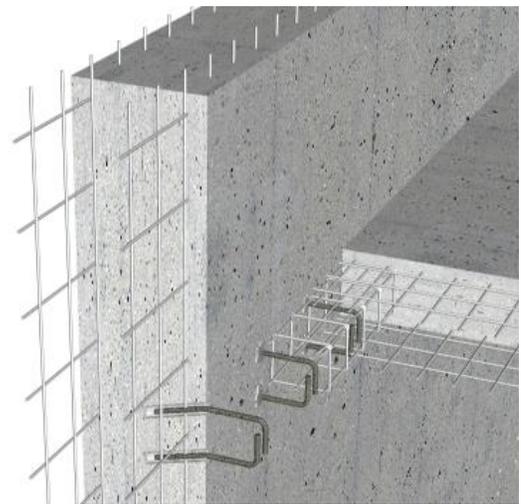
DETALLE CONSTRUCTIVO ANCLAJE MURO CON ENTREPISO RENDER
